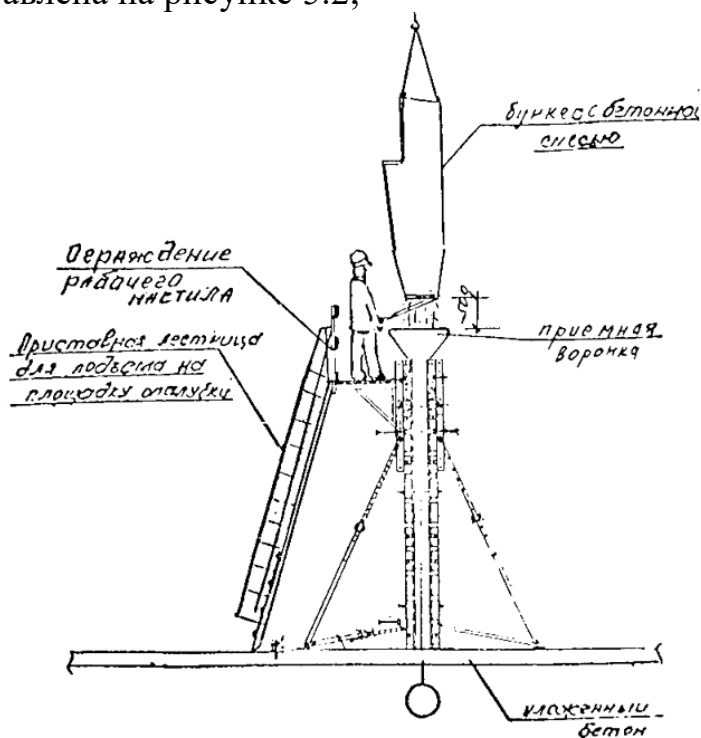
Схема бетонирования монолитной железобетонной стены
